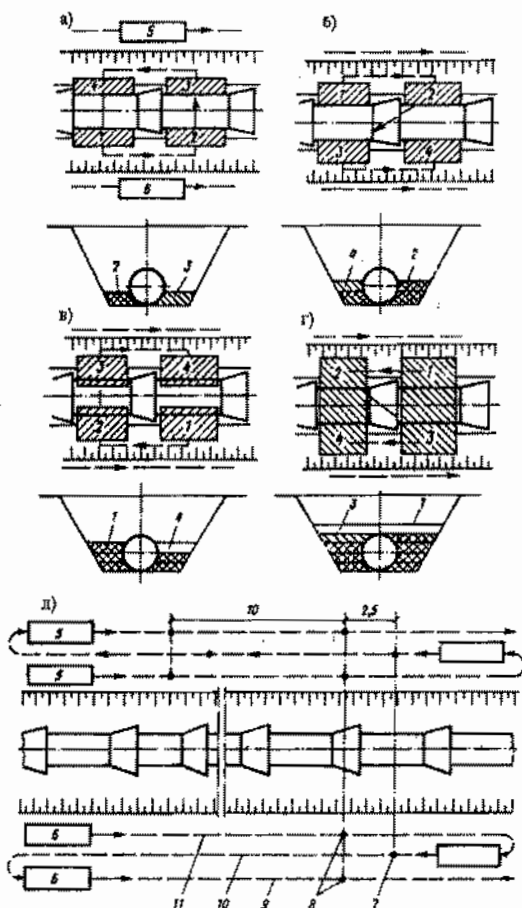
Схемы уплотнения грунта обратной засыпки железобетонного трубопровода большого диаметра (а - г) и последовательность этих работ (д): 1 - 4 - последовательность уплотнения отсыпанных слоев грунта; 5 - экскаватор с грейфером; 6 - то же, с трамбовкой; 7, 8 - места стоянки машин при уплотнении грунта; 9, 10, 11 - проходы машин
